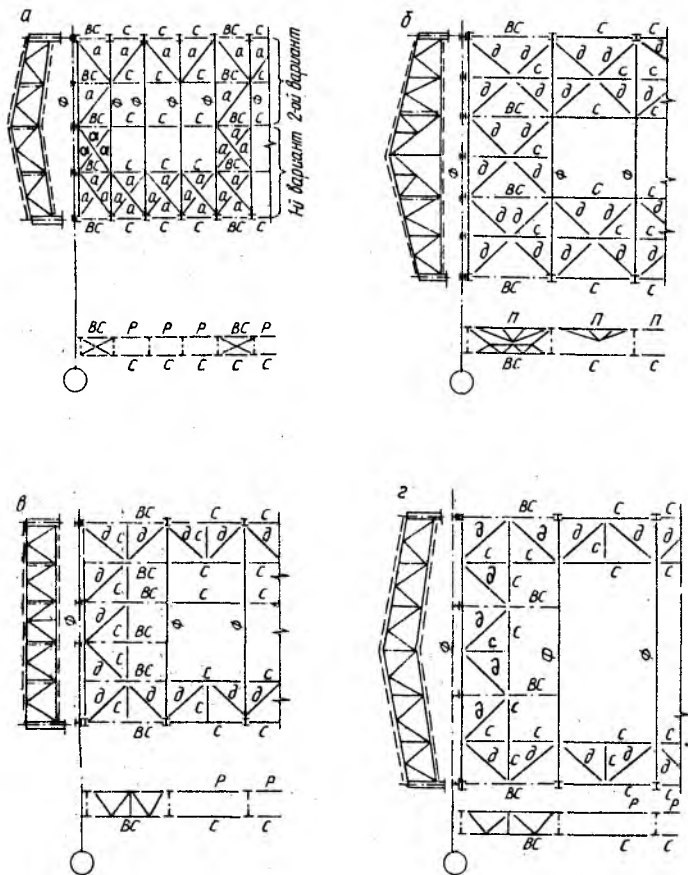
Примеры решения связей по нижним поясам стропильных ферм :
